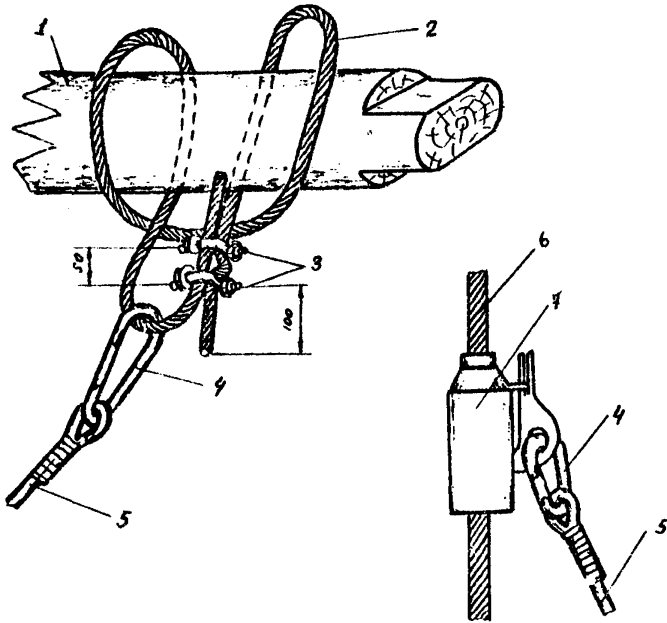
Способы прикрепления страховочного фала пояса к опорным приспособлениям:
